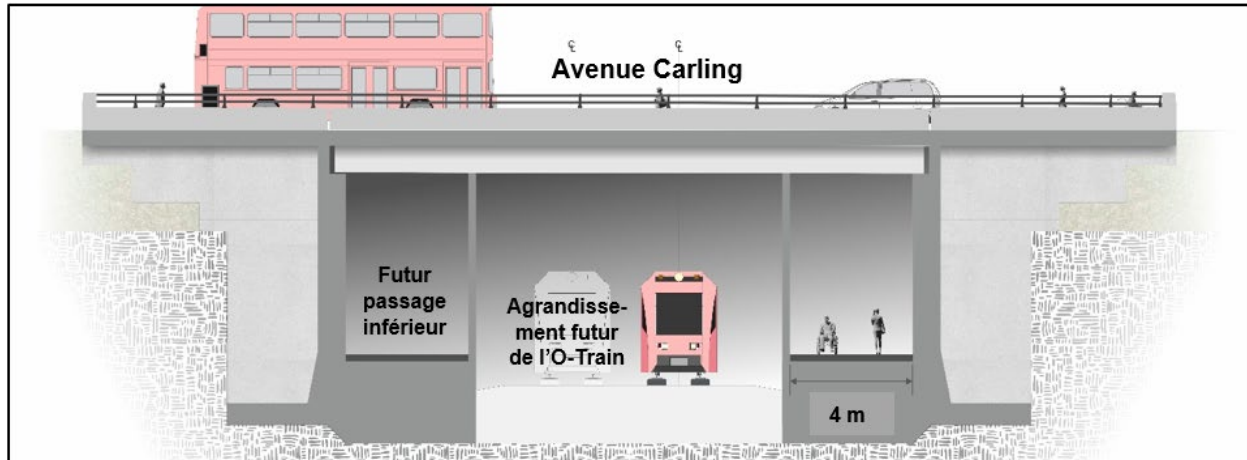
Coupe transversale du passage inférieur sous l'avenue Carling
